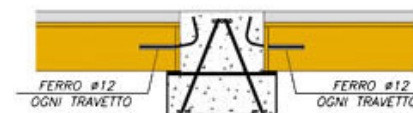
Appoggio dei pannelli Wood Beton sulle travi PREM trasversali.
